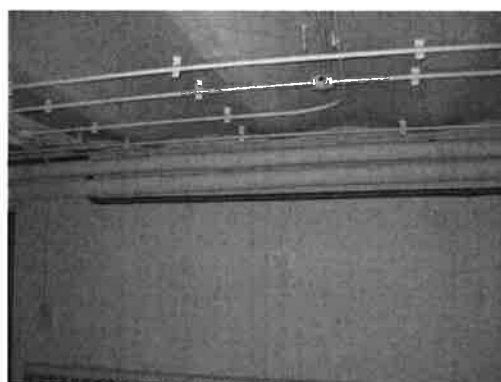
Maison dite du Directeur/-1/ caves Plâtre
